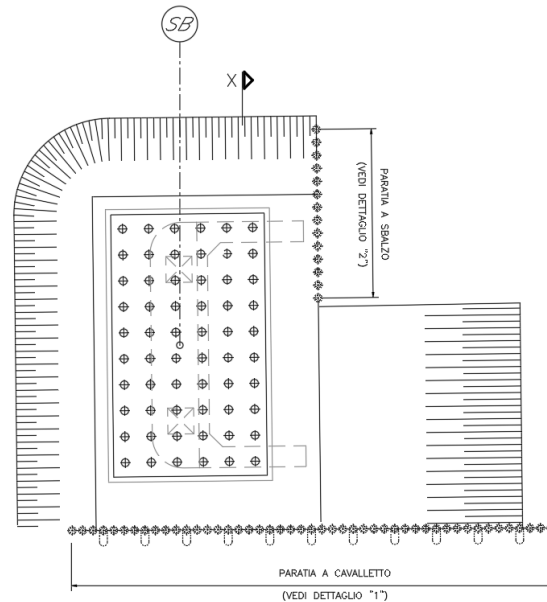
Pianta Opere Provvisionali Spalla B
